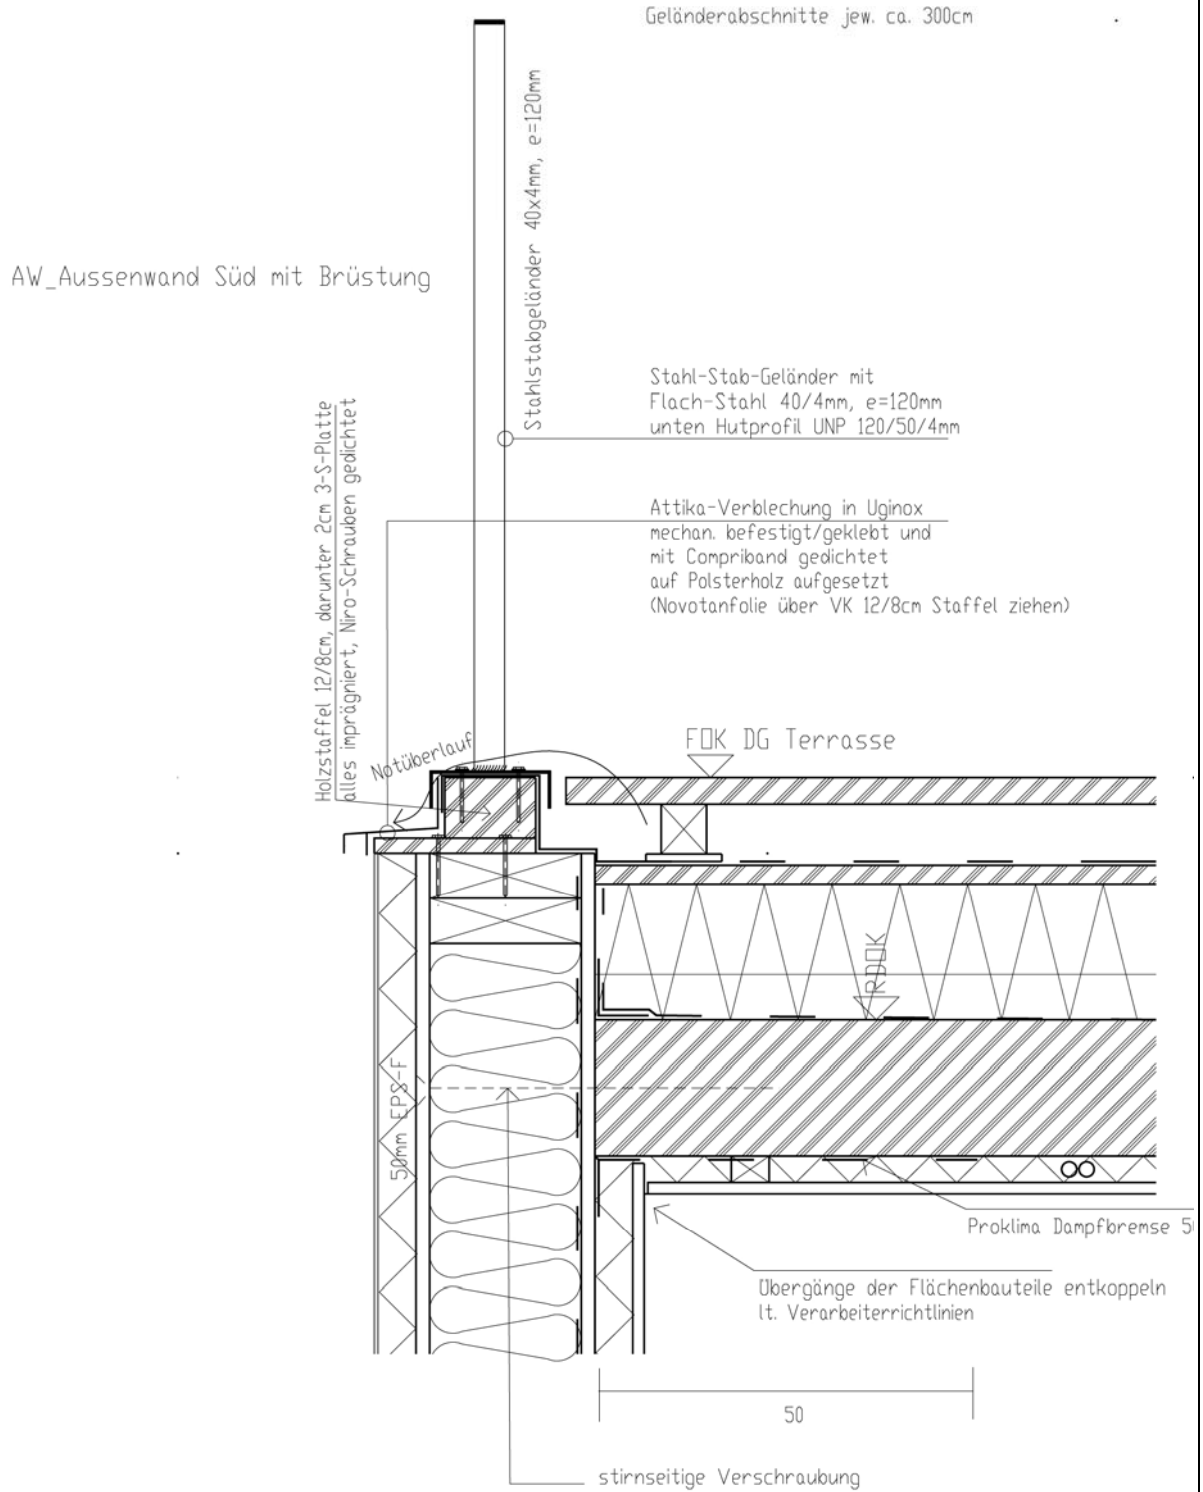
Baudetail Projekt "Smart Housing" Außenwand/Terrasse Det.01
